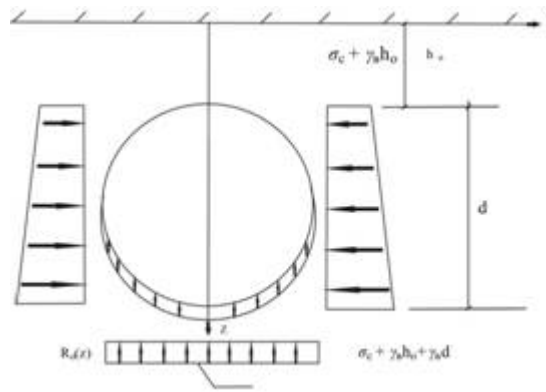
Расчетная схема по завершении проникания трубопровода в грунт дна
